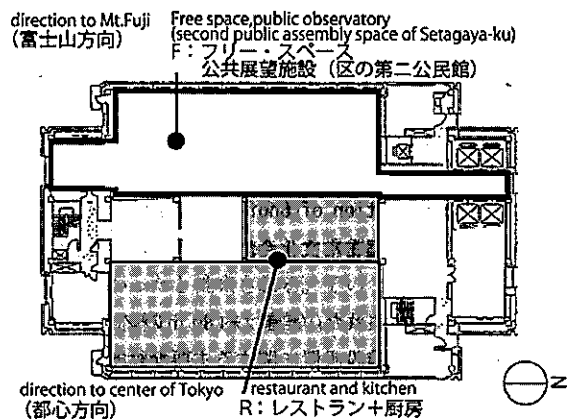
Plan of Sangencyaya carrot T. Public ob. 三軒茶屋キャロットタワー展望施設平面図 注42)
